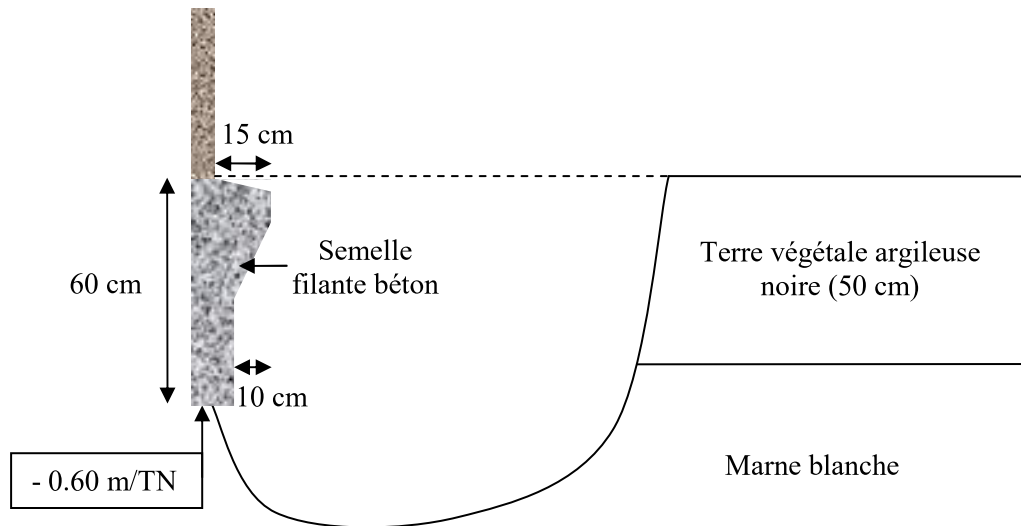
Schéma de la reconnaissance des fondations de l'existant (RF2) (échelle : 1/20).
